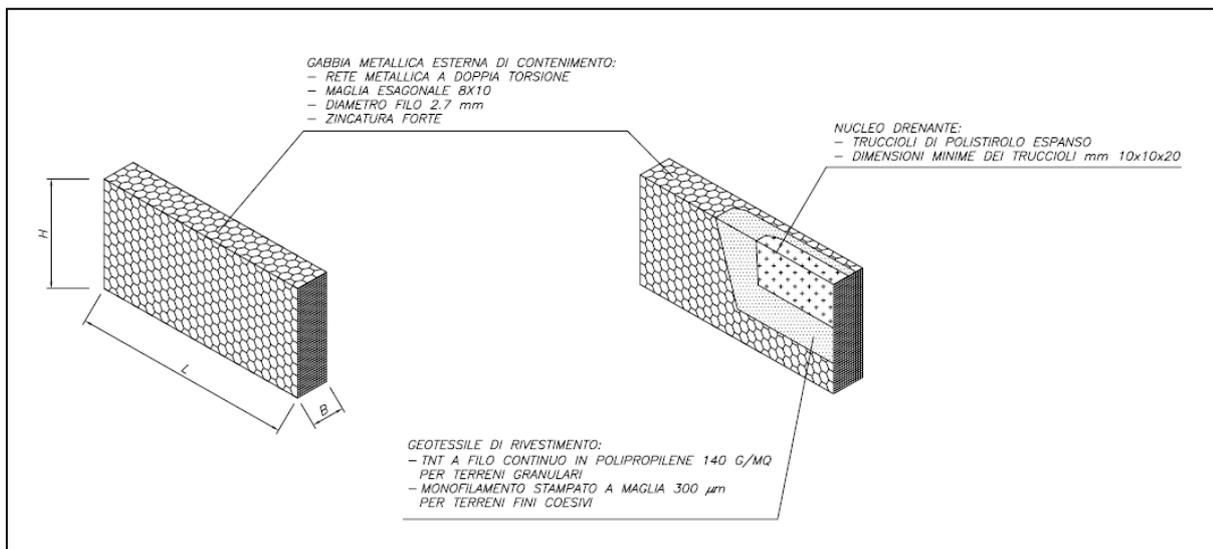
Sistema di drenaggio tipo Gabbiodren – realizzazione
